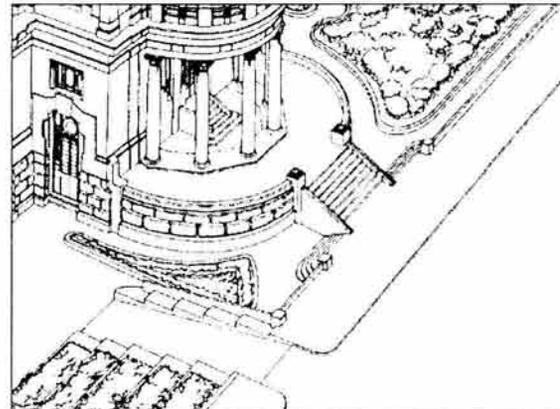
Vista parcial de la fachada lateral oriente del Palacio de Bellas Artes, obra contemporánea a la Ville des Roses. Nótese el uso de alfardas en las escalinatas de acceso en la obra más relevante de la época. Detalle de DIBUJO de Mayolo Ramírez Ruiz. PLANOTECA INBA.
